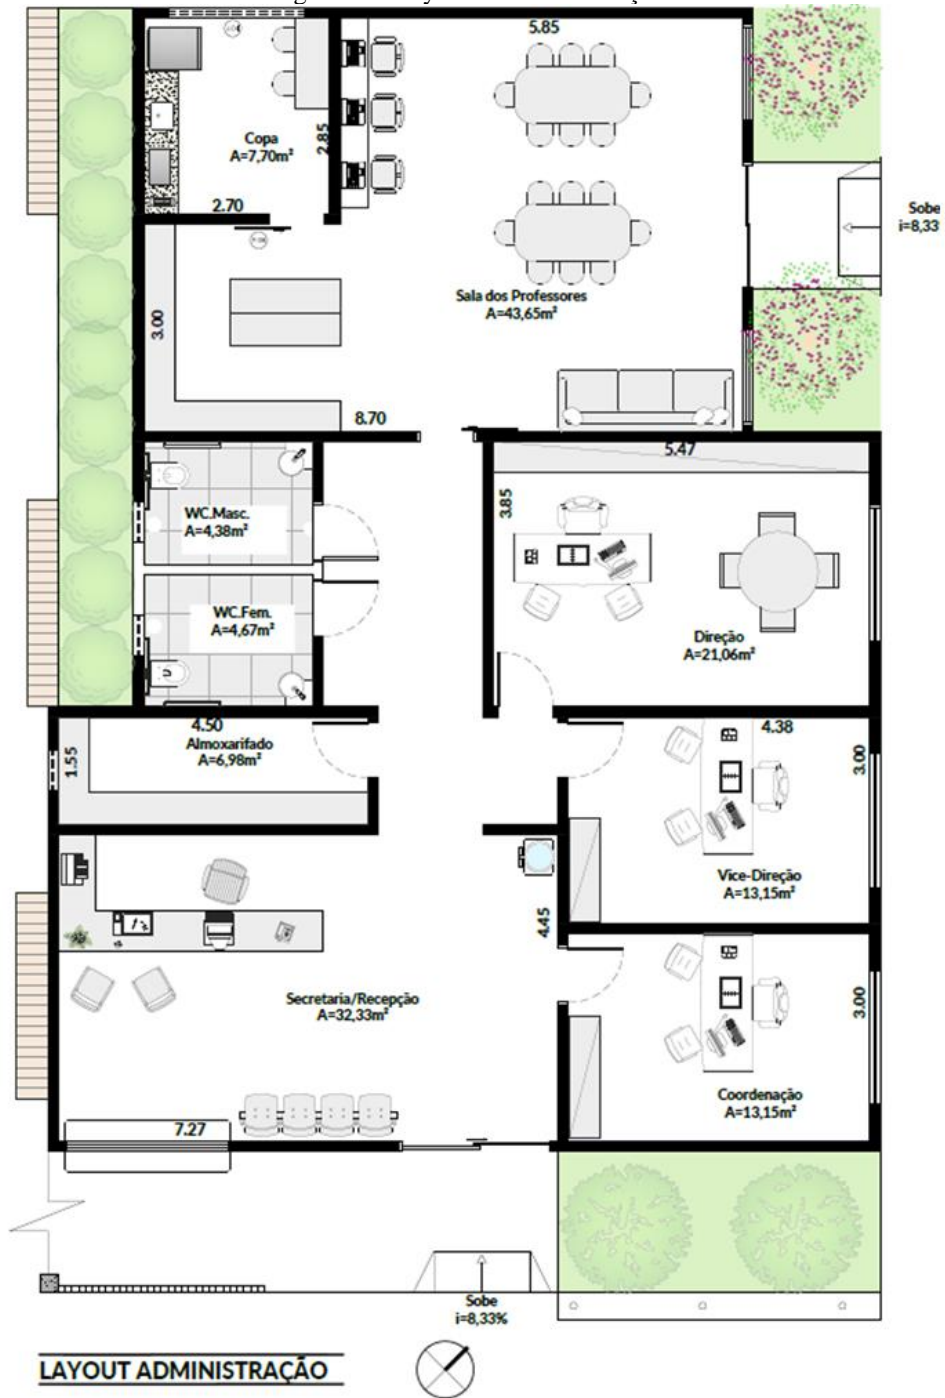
Planta baixa de reforma administrativo (sem escala).
